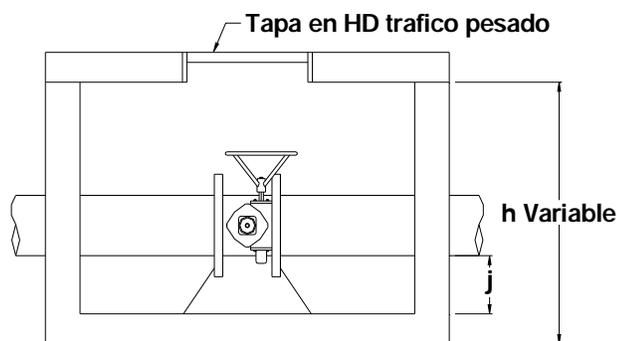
Caja en Mampostería Reforzada
